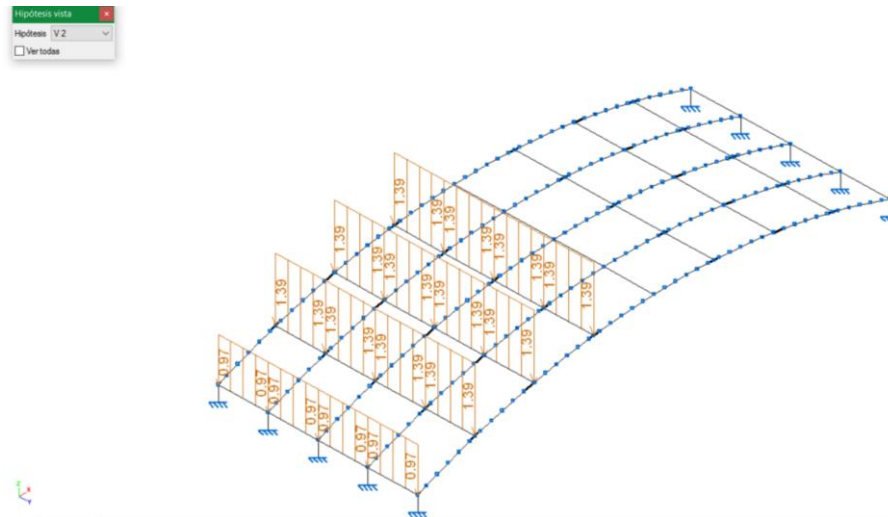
Presión interior en cubierta cerrada con huecos a barlovento
